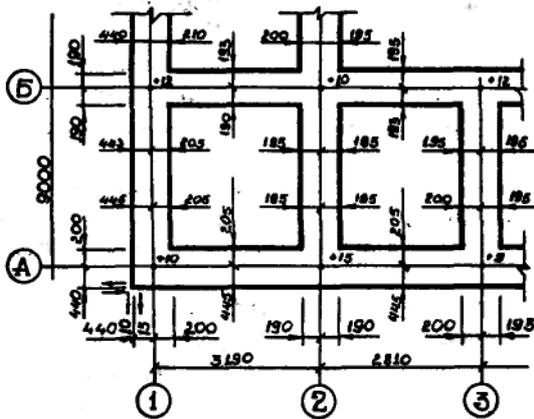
Фрагмент исполнительной схемы кирпичной кладки под перекрытие этажа
